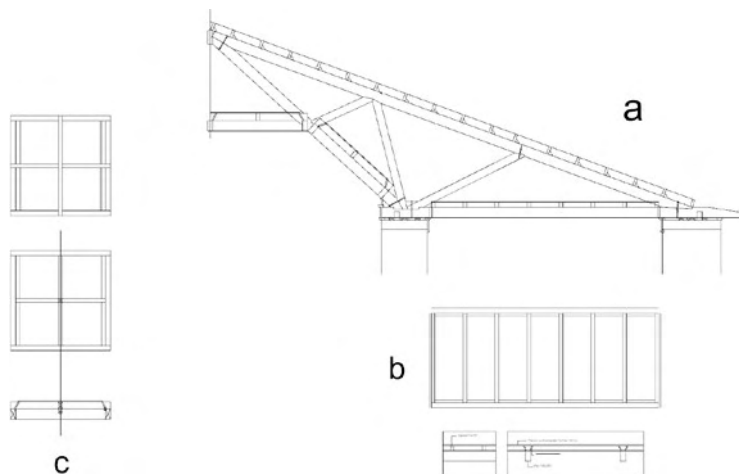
Detalle de la solución del segundo proyecto con los casetones planos.
